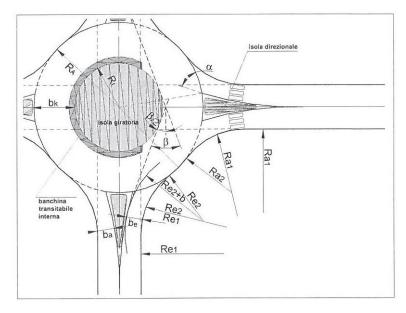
ELEMENTI DI PROGETTO E TIPIZZAZIONE DELLE ROTATORIE
